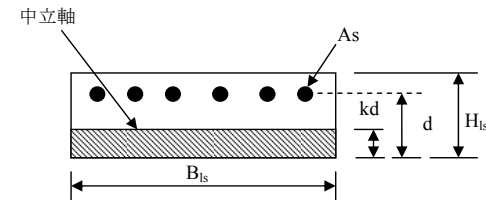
ひび割れ発生後の連結床版の断面
